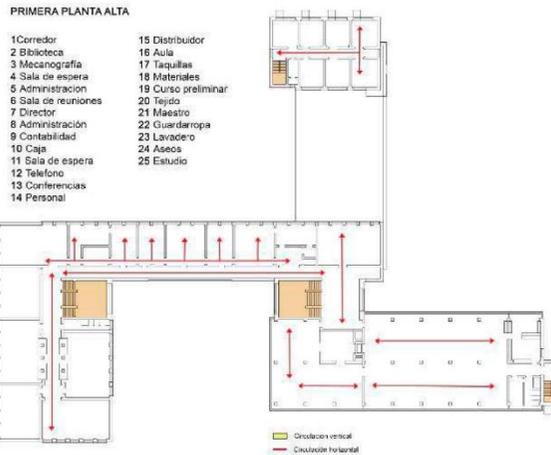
Primera planta alta - Escuela de la Bauhaus
